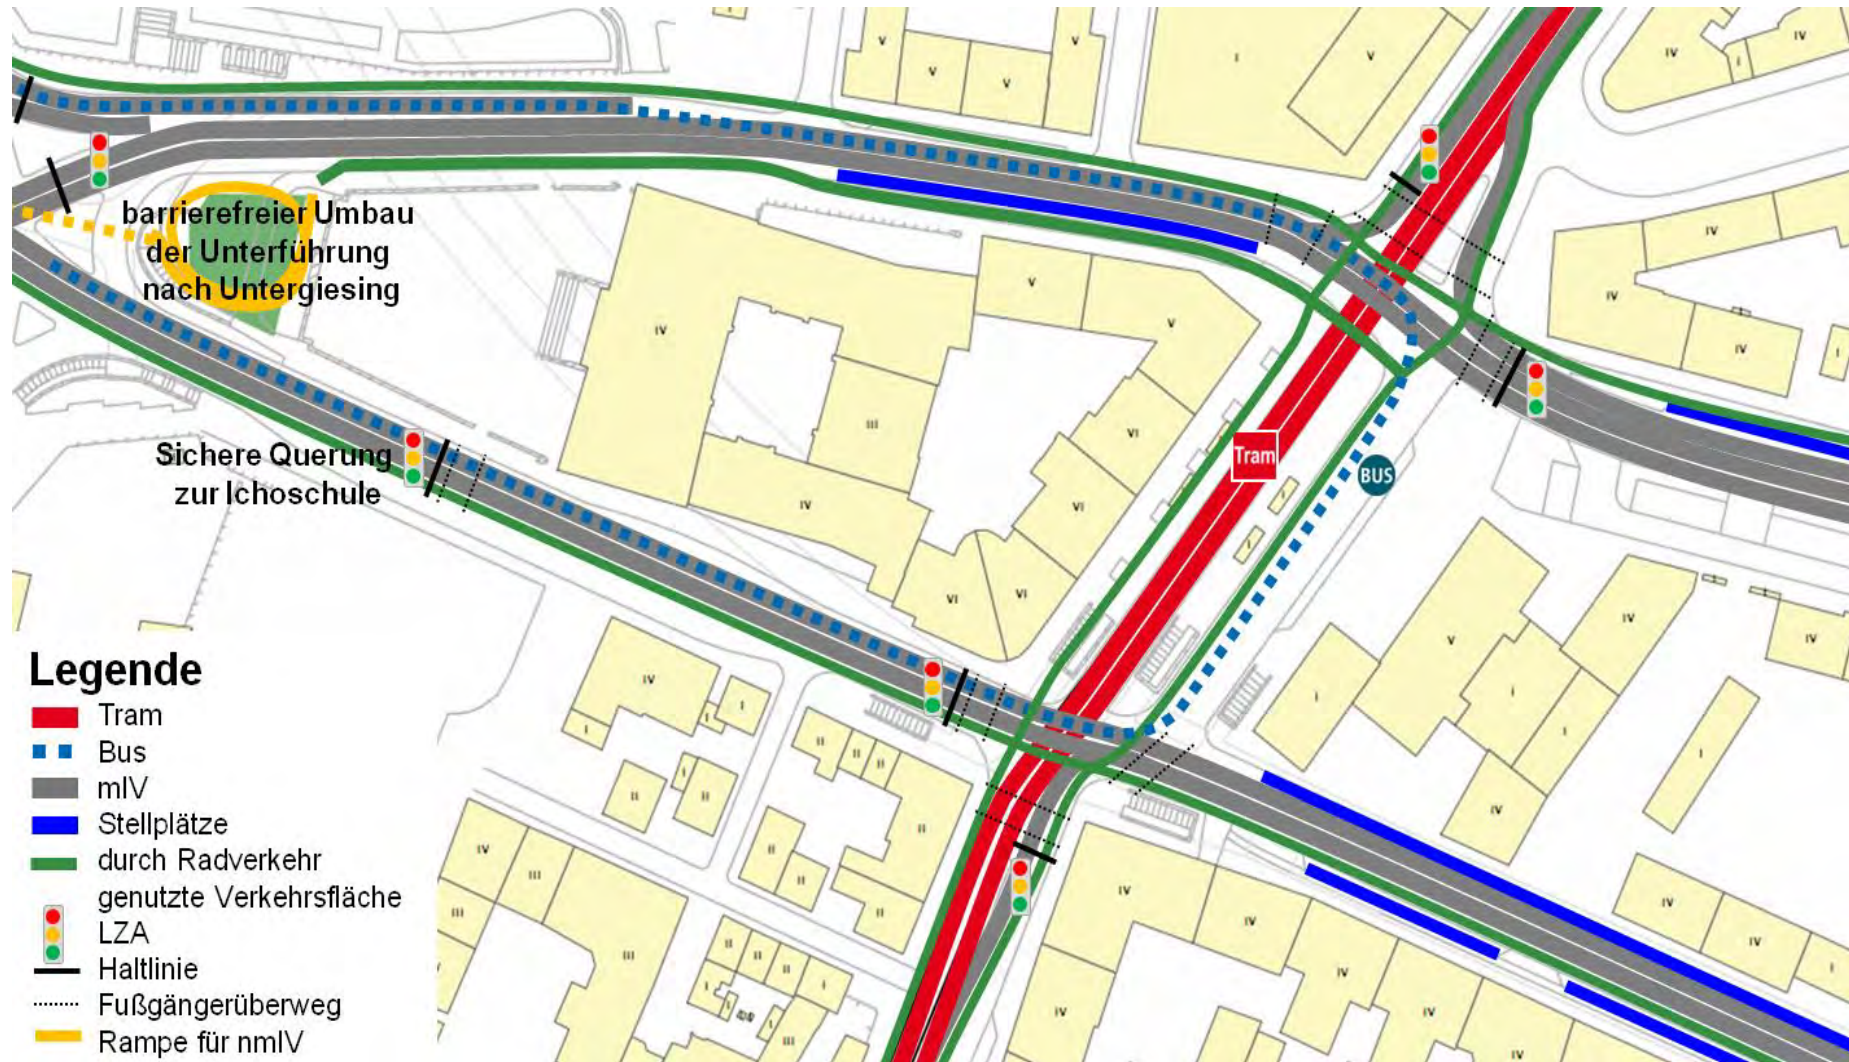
Lageplan des Einbahnstraßensystems (Variante 1)
